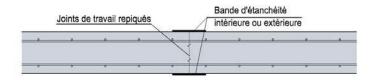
Choix des étapes de bétonnage d'un radier (plan)
